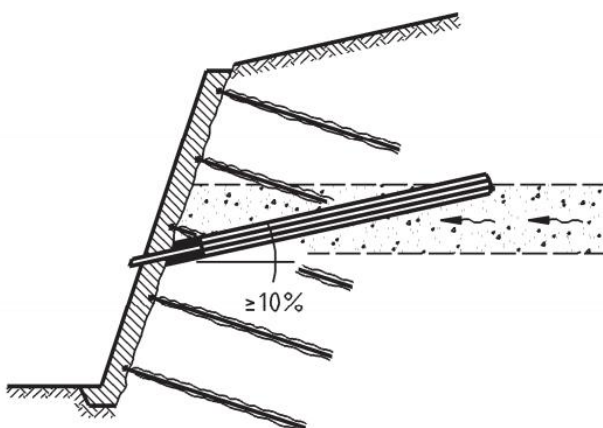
Esquema de dren californiano (Fuente: Execution of Special Geotechnical Works – Soil Nailing (BS, 2010))
